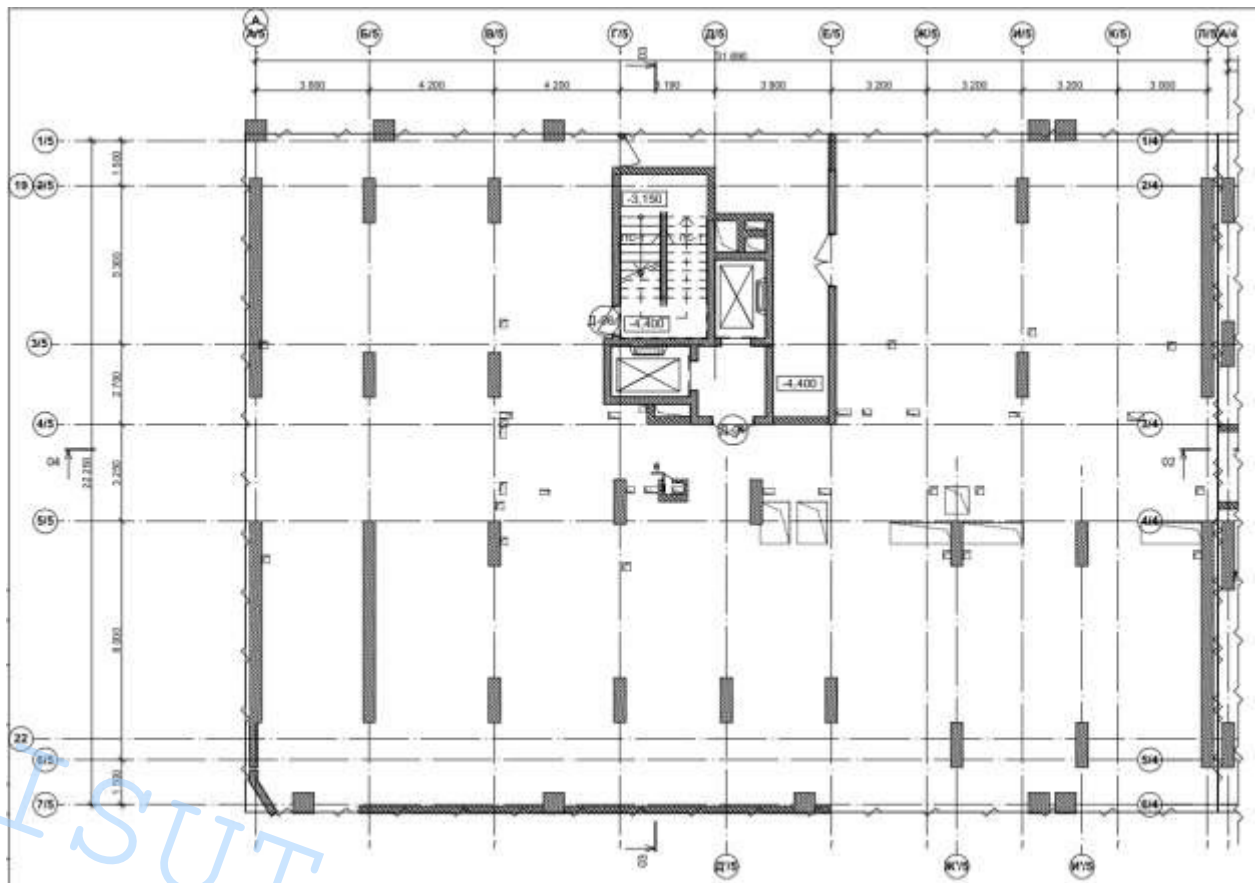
План першого поверху в монолітному багатоповерховому будинку.
